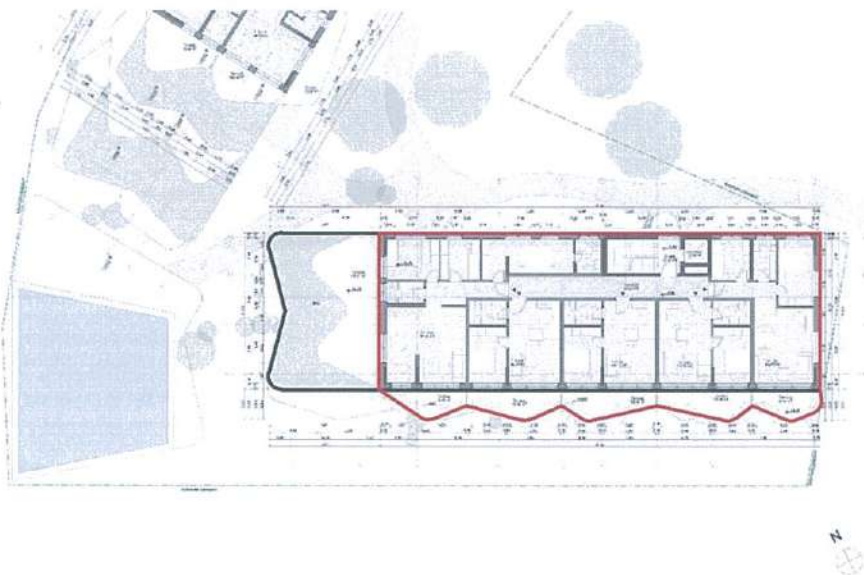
Planimetria e katit të tretë – Sip. kati të tretë 457.9m²
